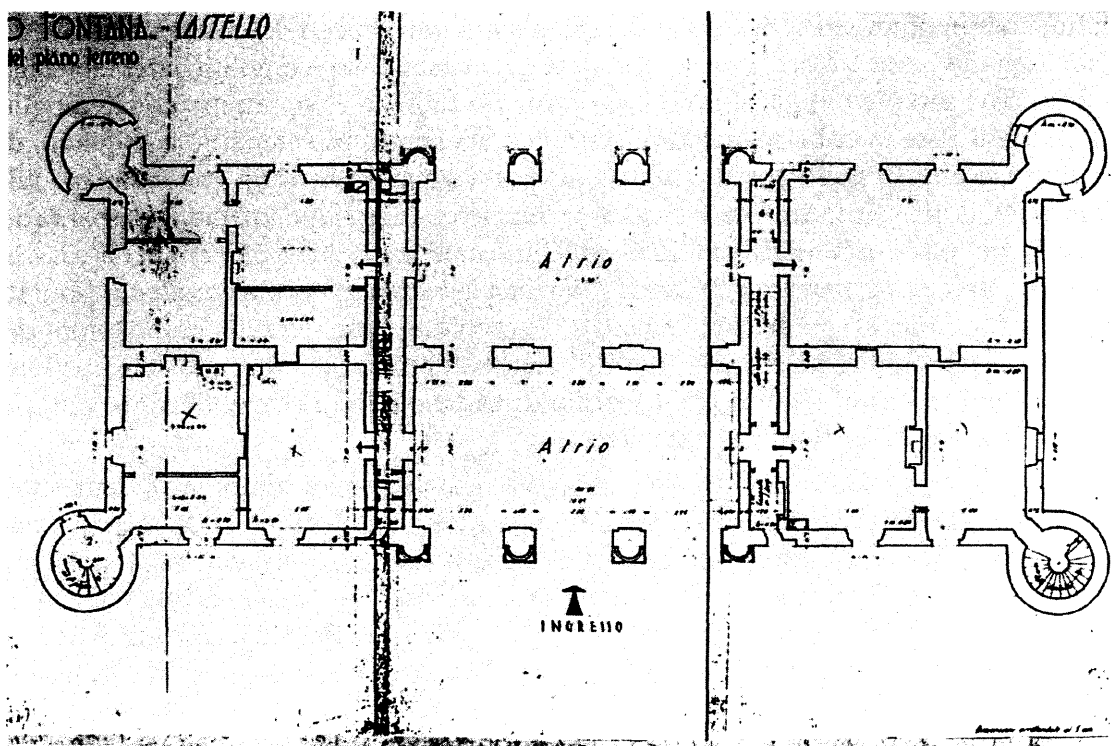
Pianta della villa di bosco Fontana a Marmirolo dove si nota l'analogia planimetrica dell'atrio passante e la distribuzione laterale degli ambienti.
